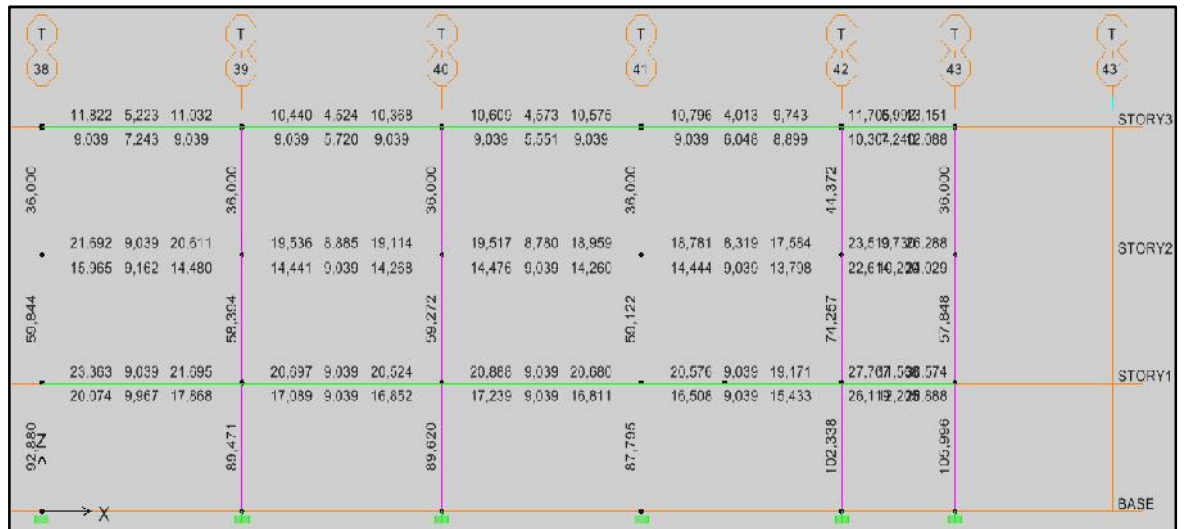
Acero en vigas pórtico T, Consulta Externa I
